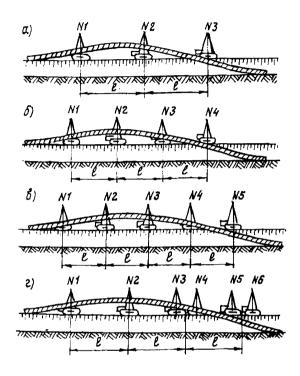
Схемы расположения трубоукладчикот при раздельной укладке изолированных трубопроводов различных диаметров с применением мягких монтажных поло тенец:
